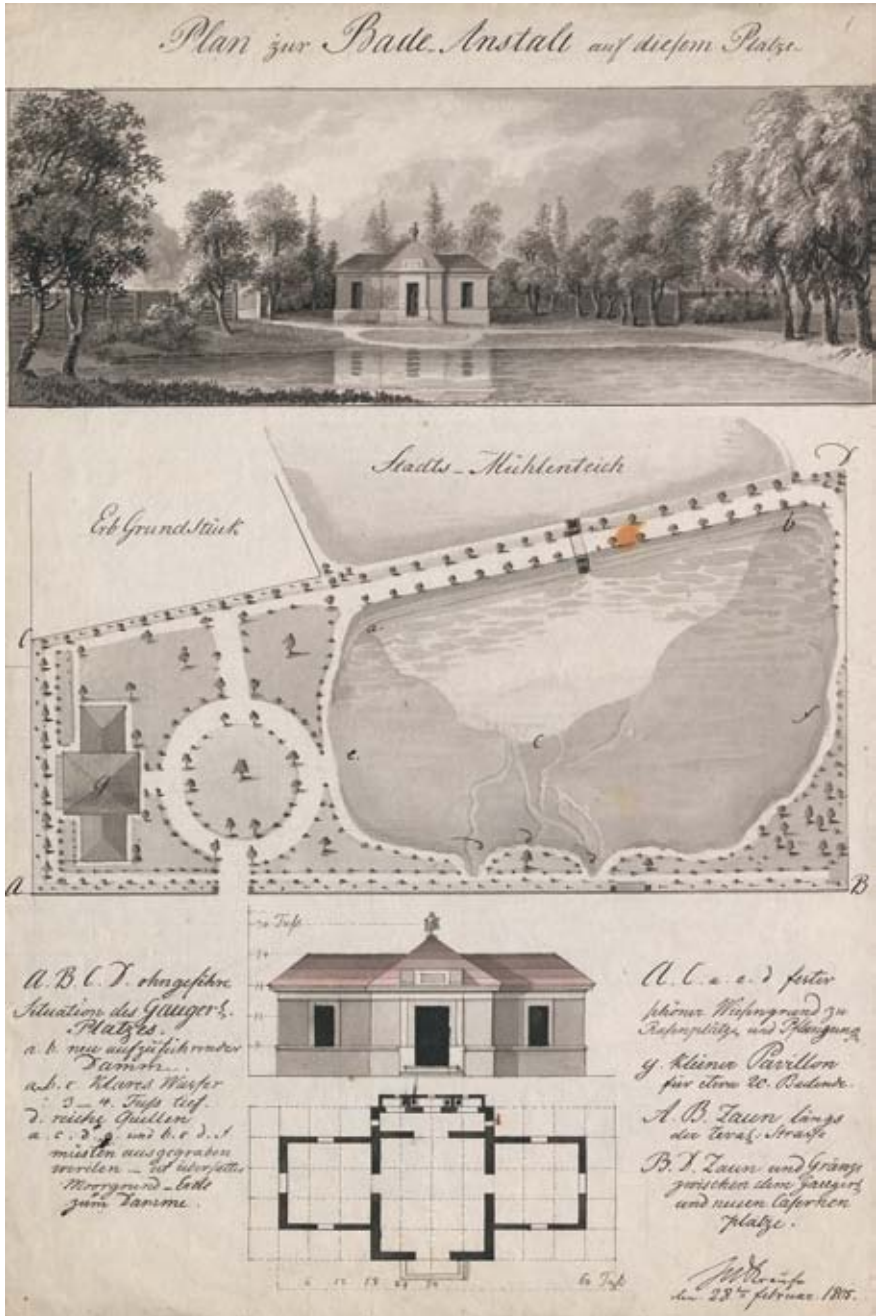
Johann Wilhelm Krause. Plan zur Bade-Anstalt in Dorpat. Ansicht, Grundriss, Aufriss. Bez. u. r.: „JW Krause (ligiert) den 28ten Februar 1805“. Tartu, Universitätsbibliothek, 9-37-1.
